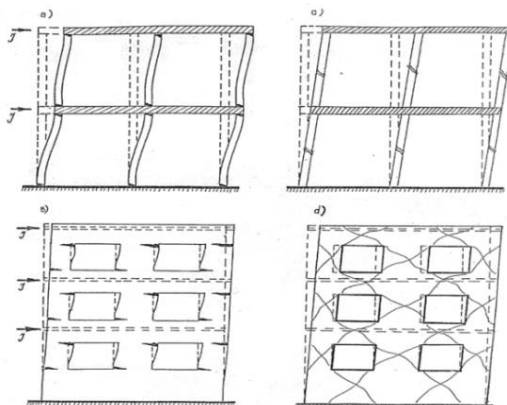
Каркасное здание и стены с проемами: *a, б* ожидаемые схемы разрушений; *в, г* фактические схемы разрушений
